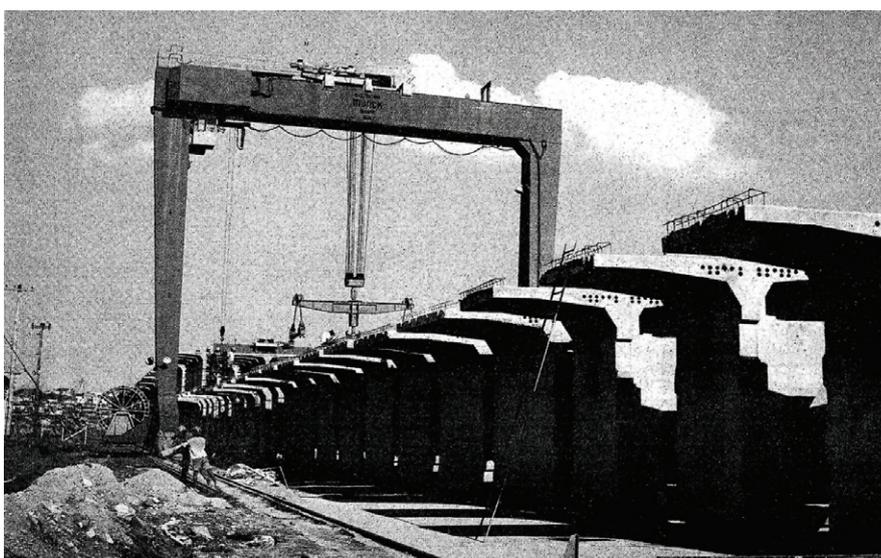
CANTEIRO DE PRÉ-FABRICAÇÃO NA ILHA DO FUNDÃO, NA CIDADE UNIVERSITÁRIA
